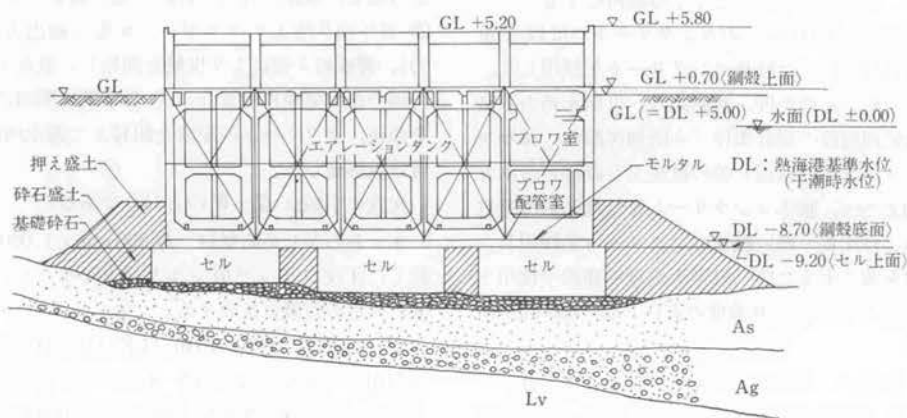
セル基礎、鋼殻ケーソン、下水処理施設横断面図
